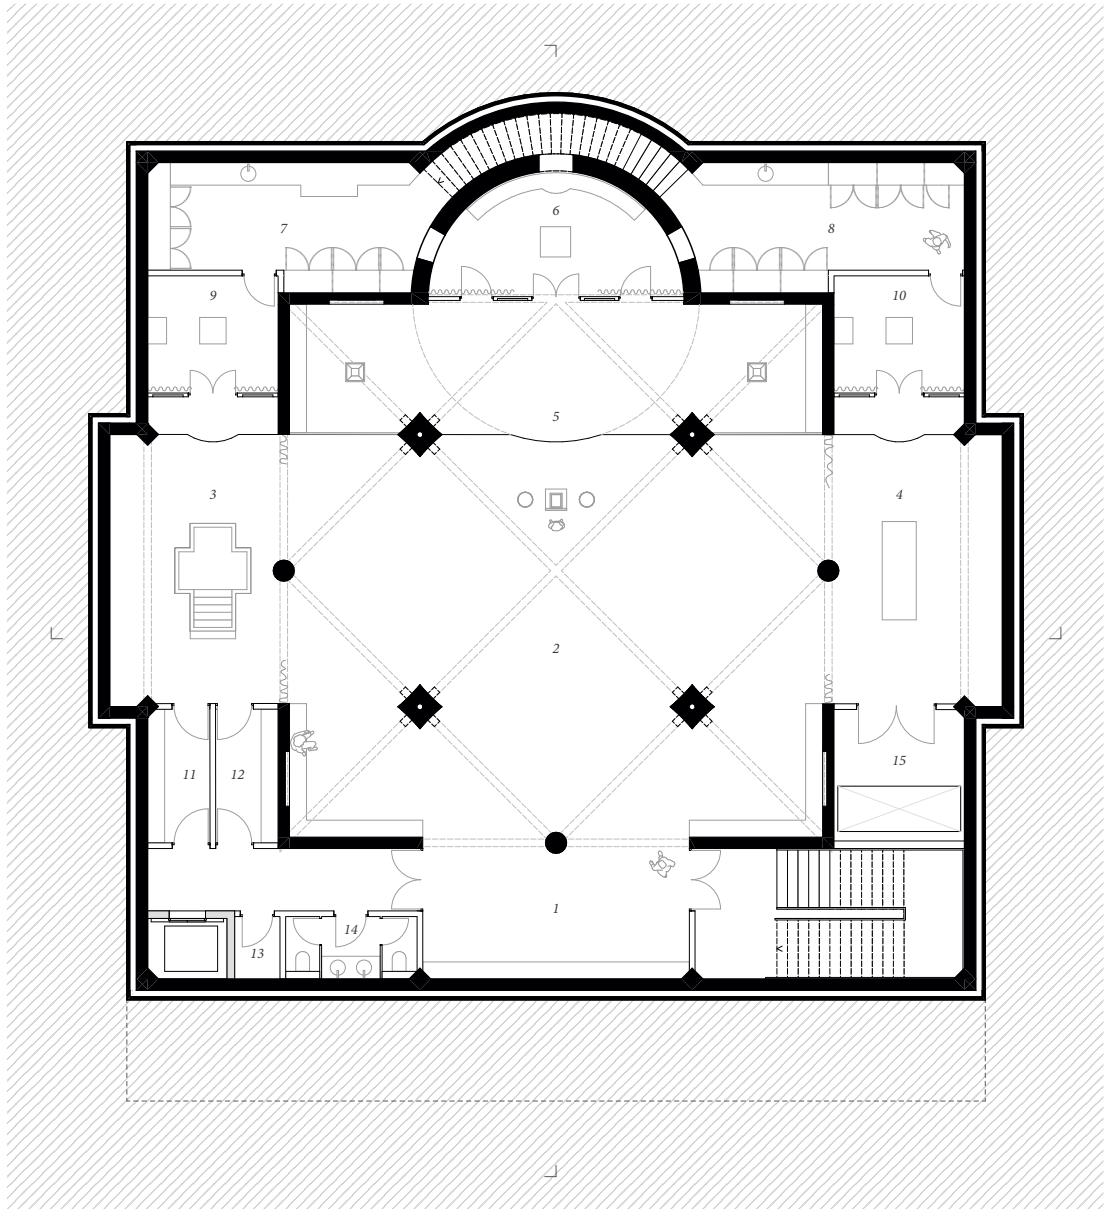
Grundriss Untergeschoss, M 1:200
